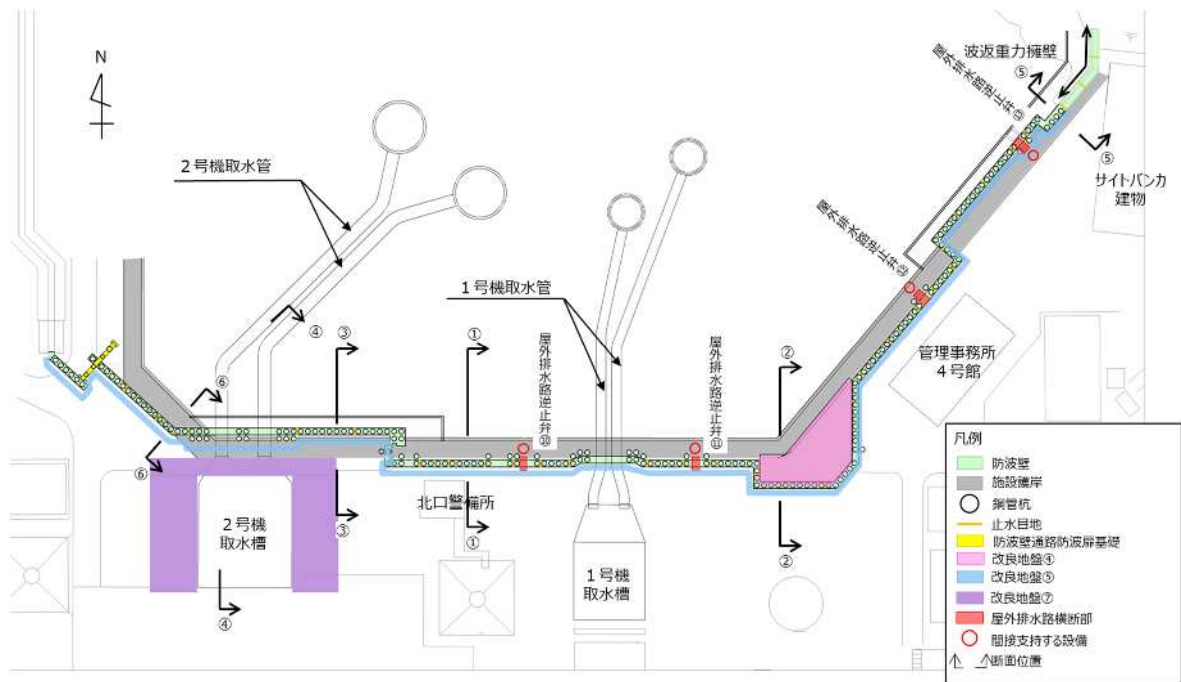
防波壁（多重鋼管杭式擁壁）平面配置図
